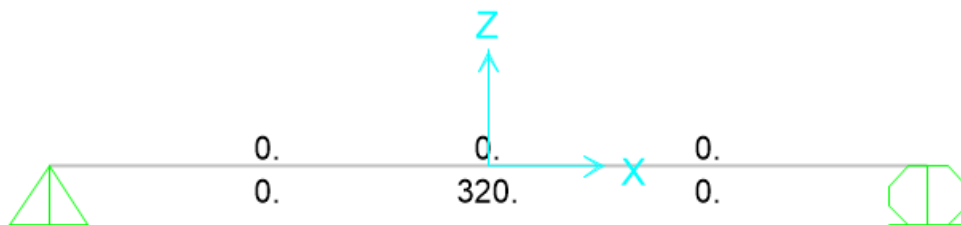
Área de refuerzo longitudinal requerido (en mm²)
